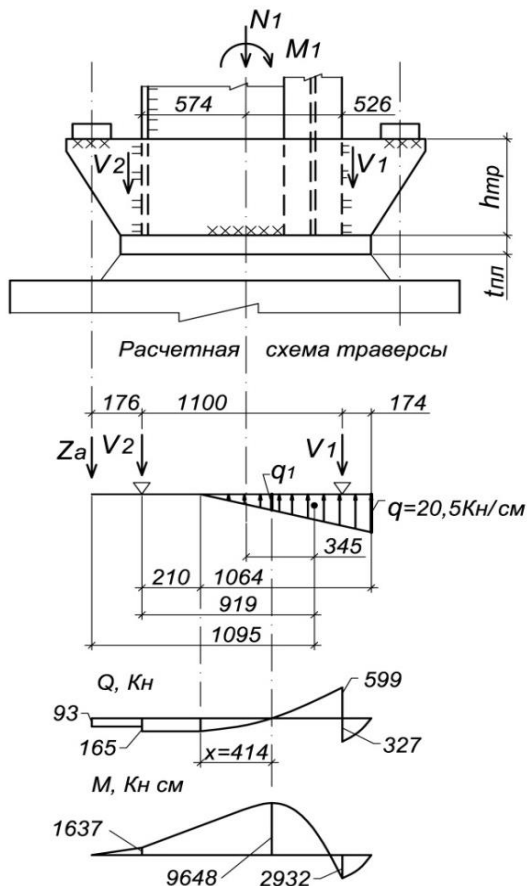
Траверса колонны. Расчетная схема траверсы и эпюры внутренних усилий
